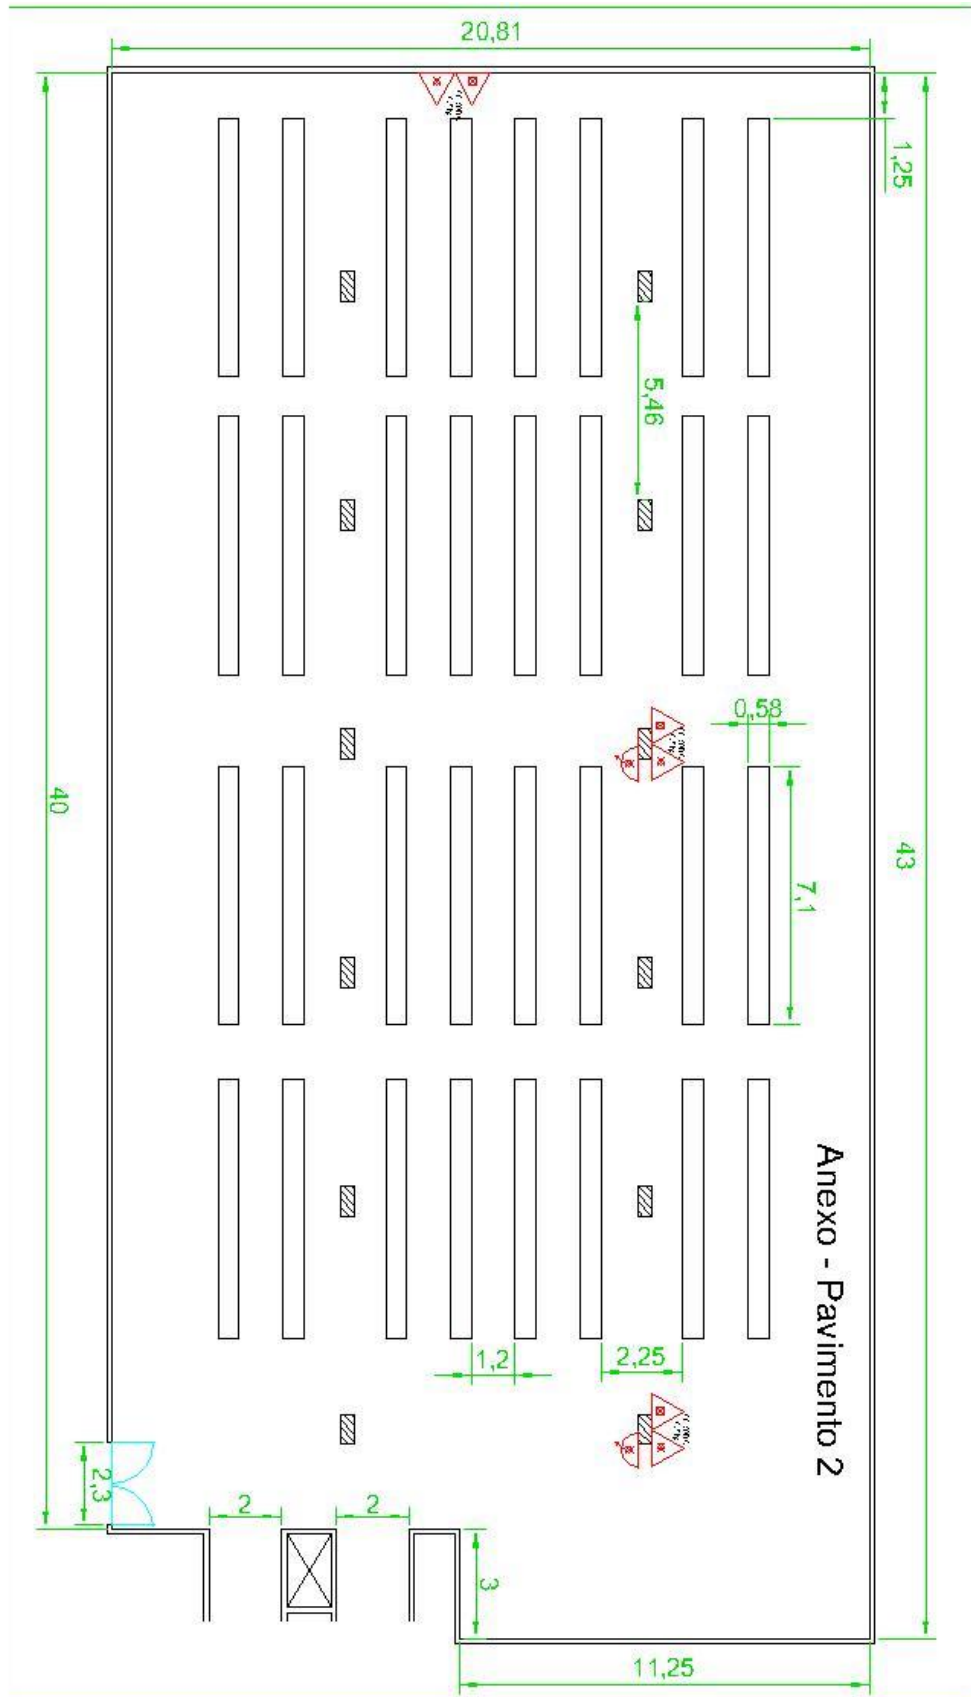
Posição dos extintores de incêndio e hidrantes na planta baixa do pavimento 2
